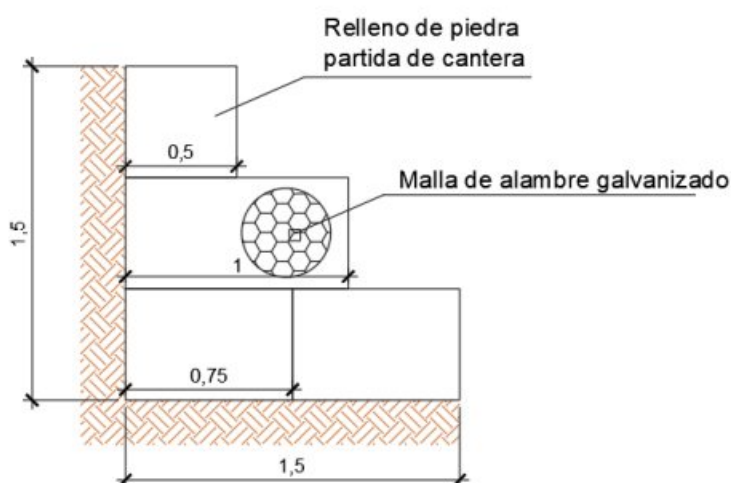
Sección transversal típica del muro de gaviones; Fuente: elaboración propia.
